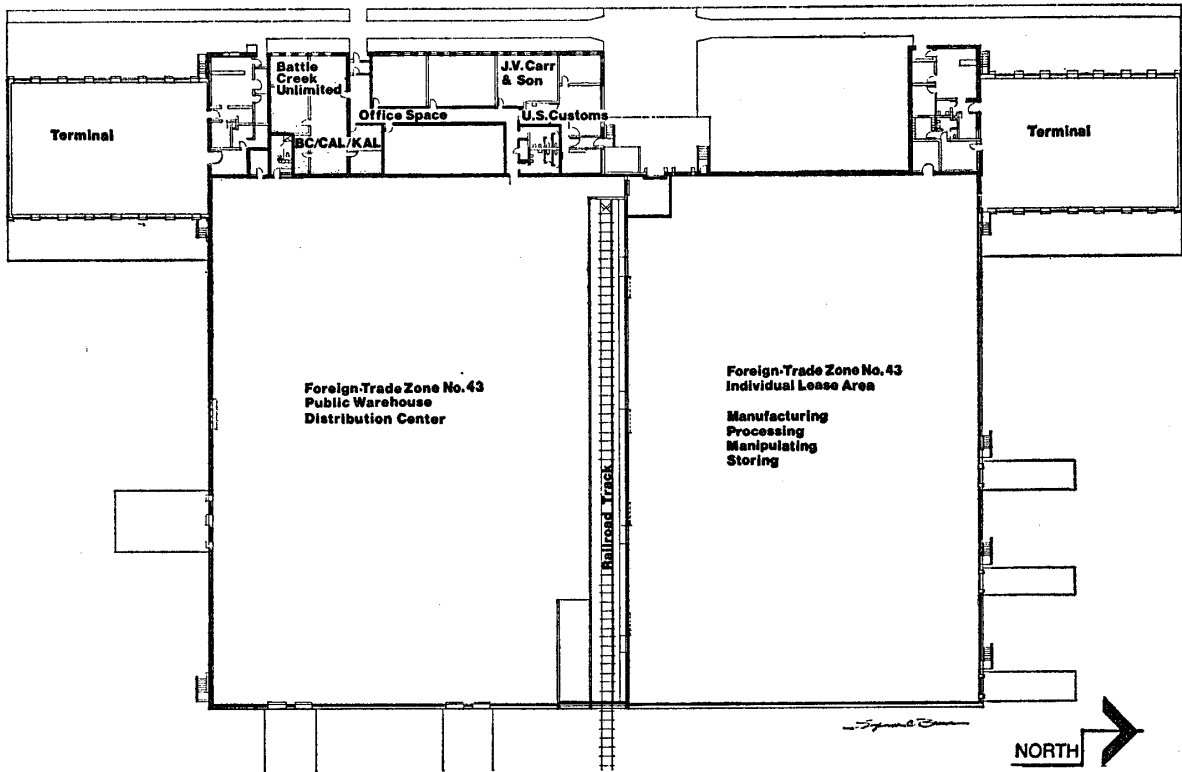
FOREIGN-TRADE ZONE #43/CARGO FACILITY FLOOR PLAN
